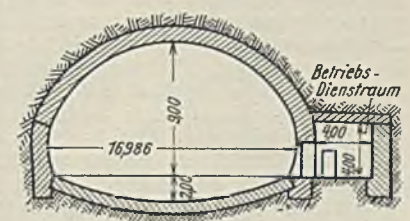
Querschnitt durch die Mitte der Tunnelstation.
